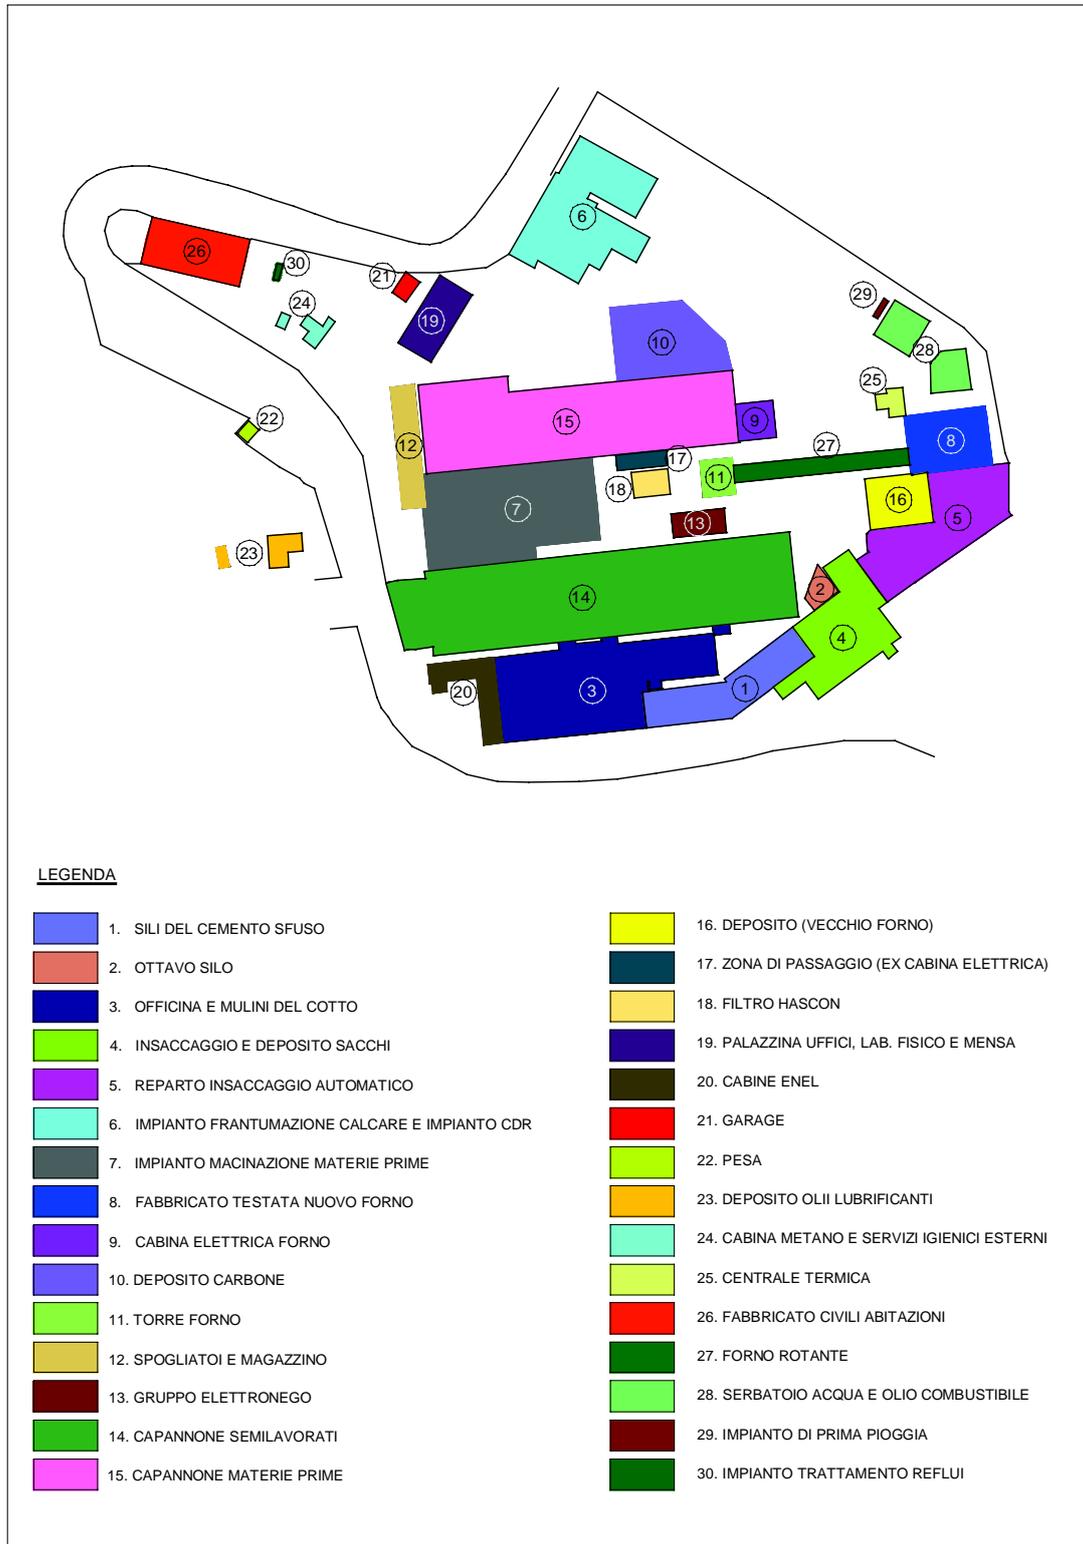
Planimetria dello stabilimento con indicazione dei fabbricati industriali
